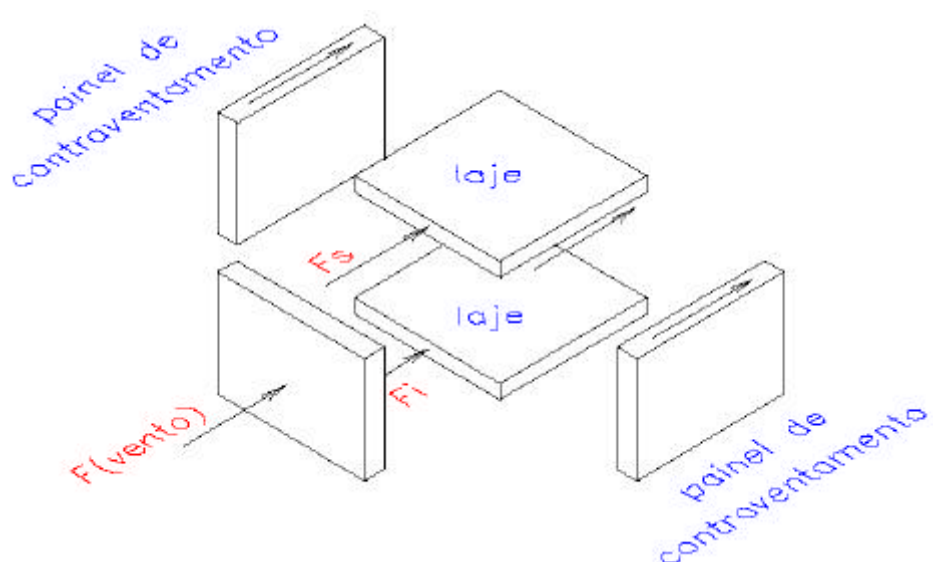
Atuação do vento e distribuição para os painéis de contraventamento
